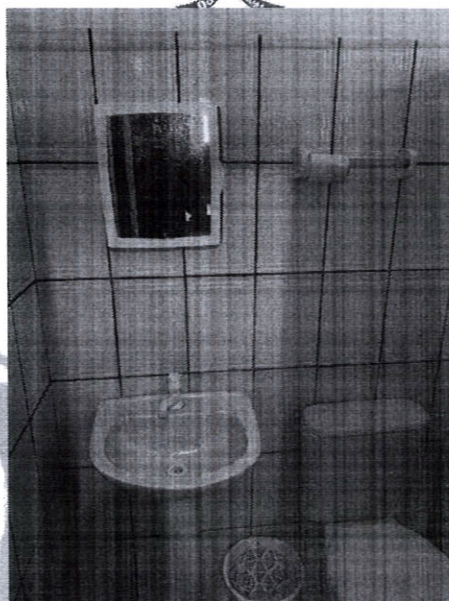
Vista de um dos banheiros em bom funcionamento.
